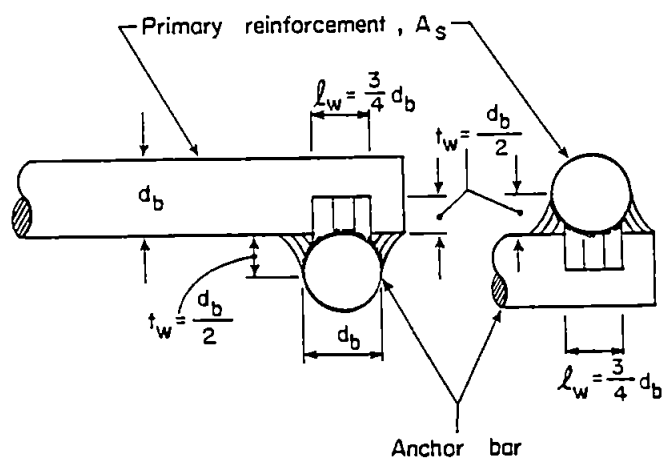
Detalle de soldadura empleada los ensayos de la referencia 11.34.
